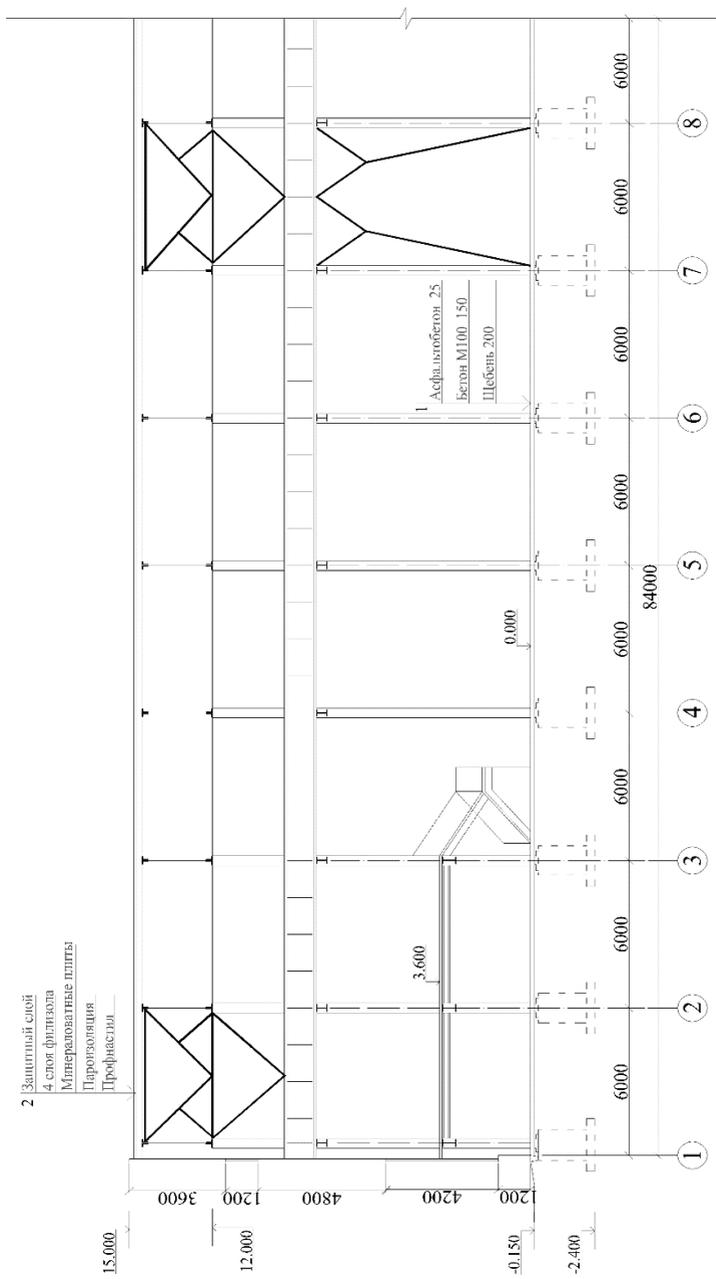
Пример фрагмента продольного разреза производственного здания с опорным мостовым краном, с металлическим каркасом и одинаковым шагом колонн и стропильных конструкций:
